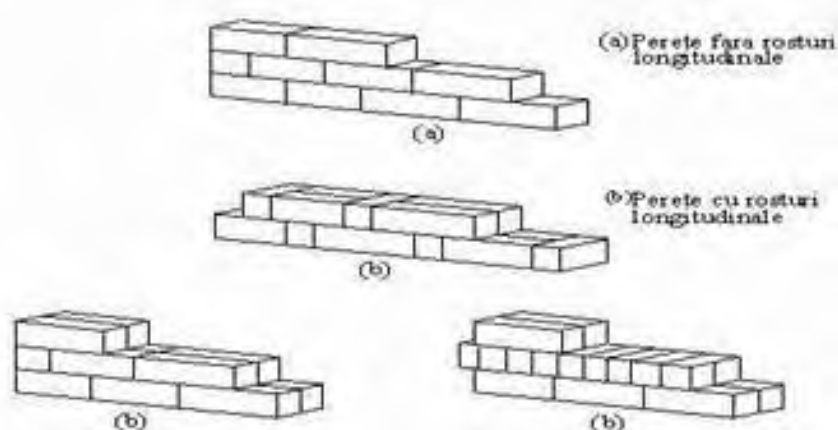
Tipuri de zidării (a) Nu există mortar în plan paralel cu peretele și (b) Există mortar în plan paralel cu peretele [11]
